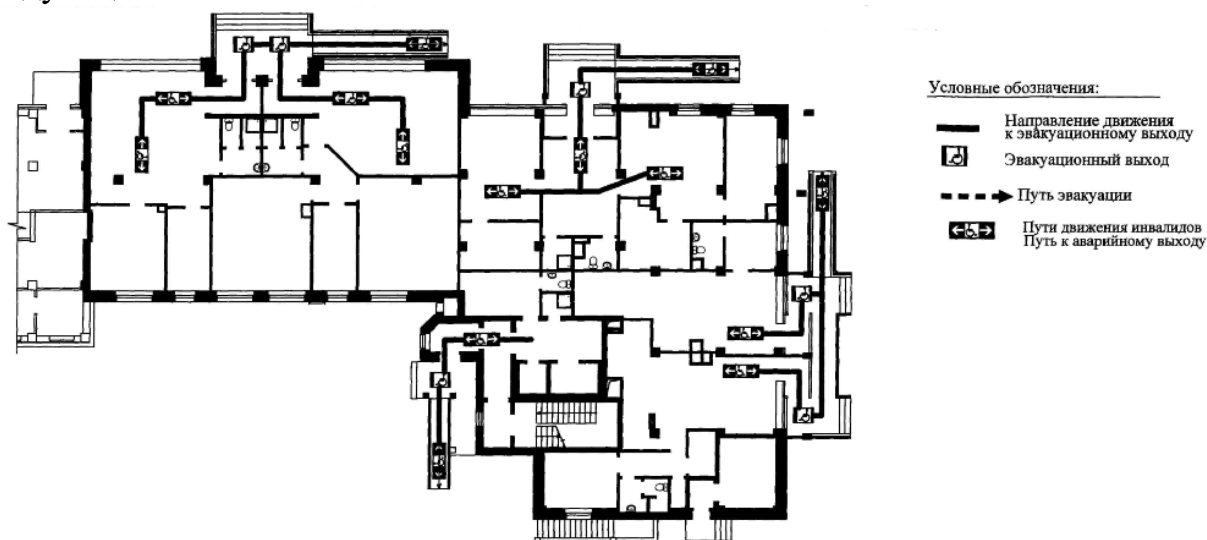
План путей перемещения и эвакуации жильцов с 1 этажа.
